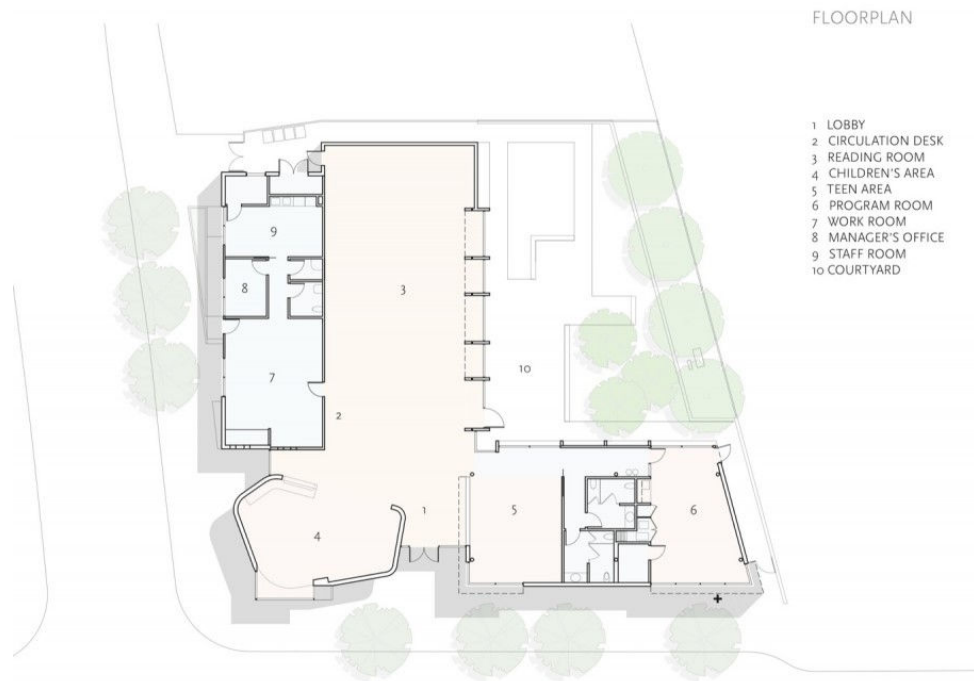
Planta baixa (FLETCHER, 2009).
